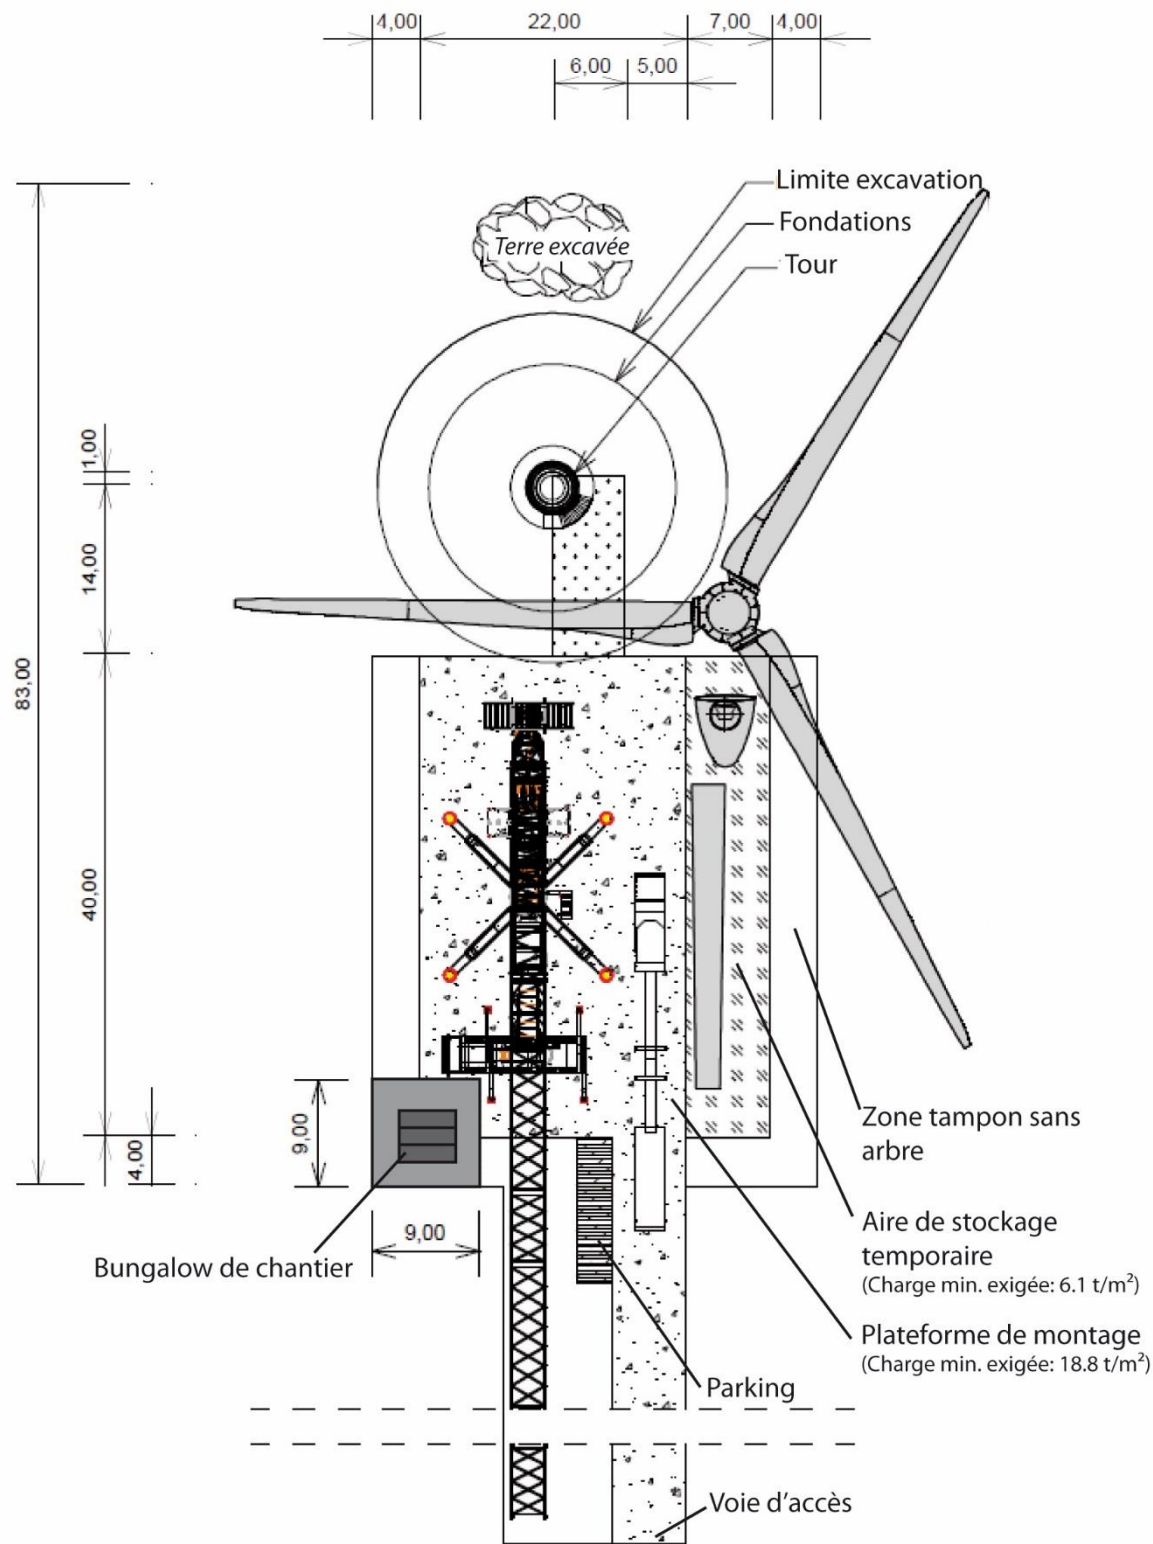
Plan-type d'une plateforme de montage pour une E-82 E4 – 110 m
